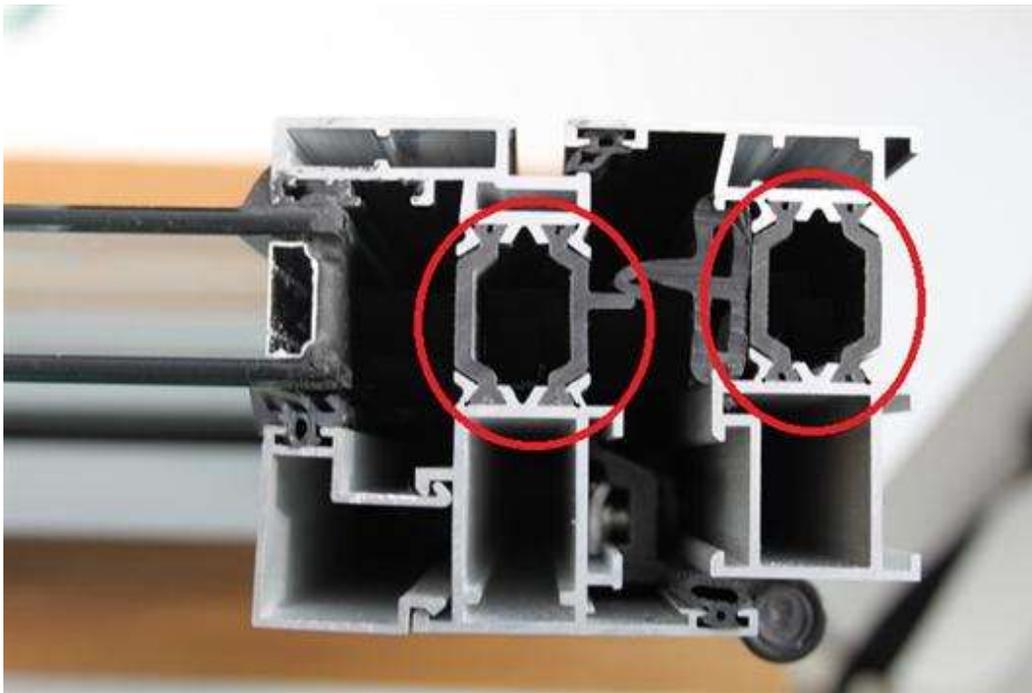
Detalle de una carpintería (marco) con rotura de puente térmico.
